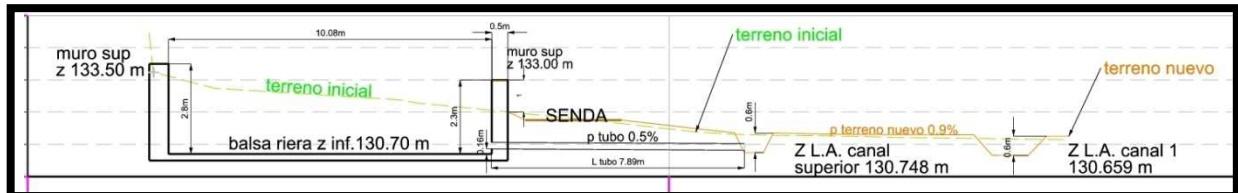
Detalle longitudinal conexión balsa riera y canal superior.
